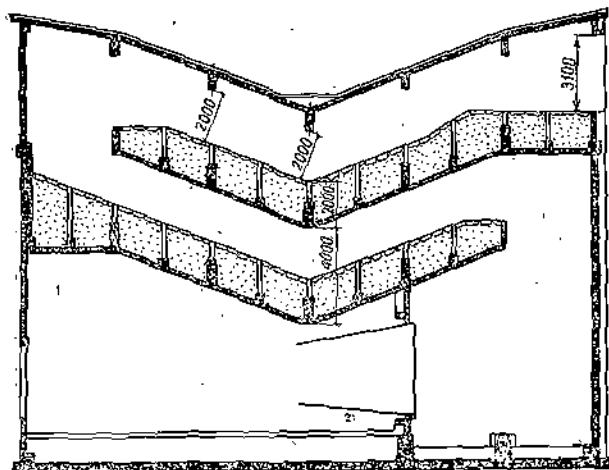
Схема и основные размеры двухэтажного глушителя с насыпным звукопоглотителем
